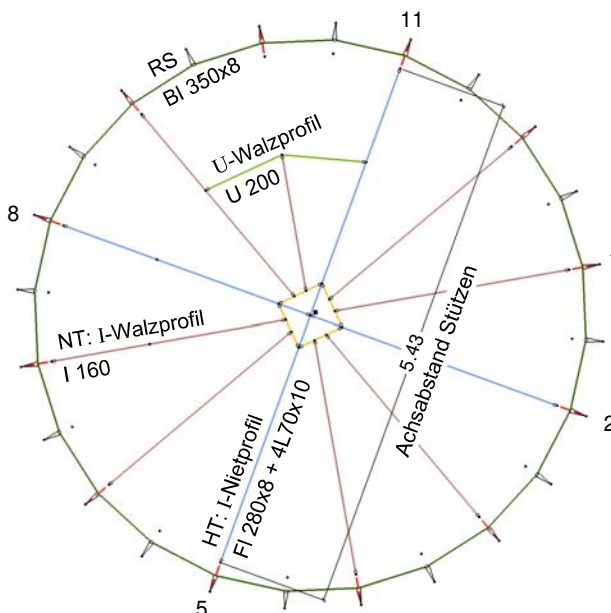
Grundriss Decke über Keller mit Querschnittsbezeichnungen
